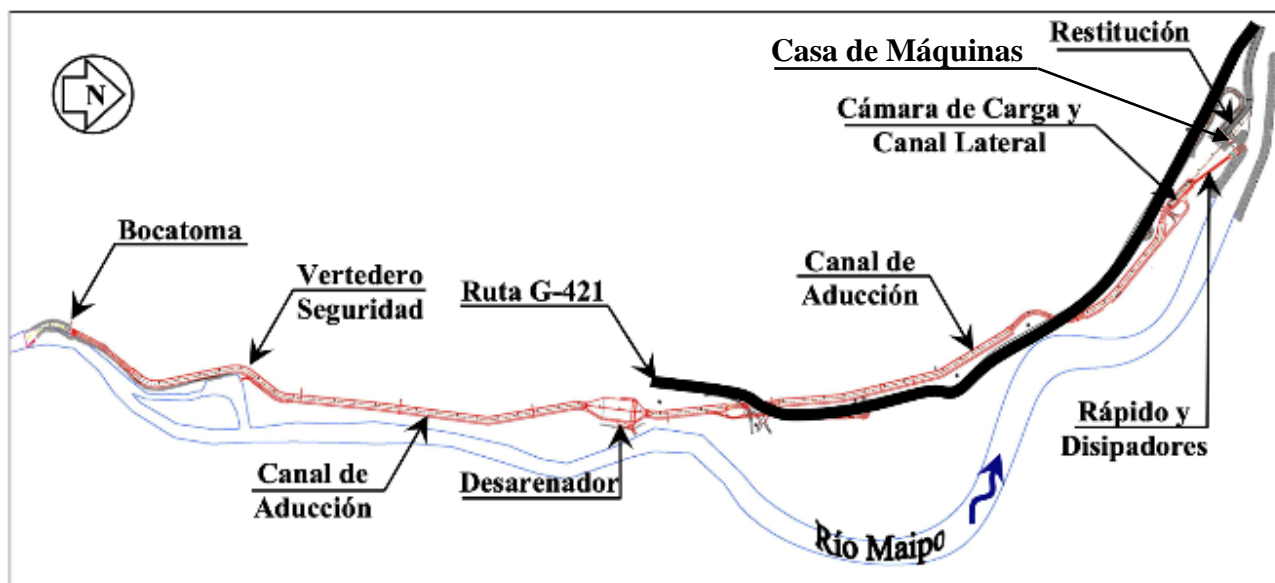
Esquema de la ubicación de las obras construidas.
